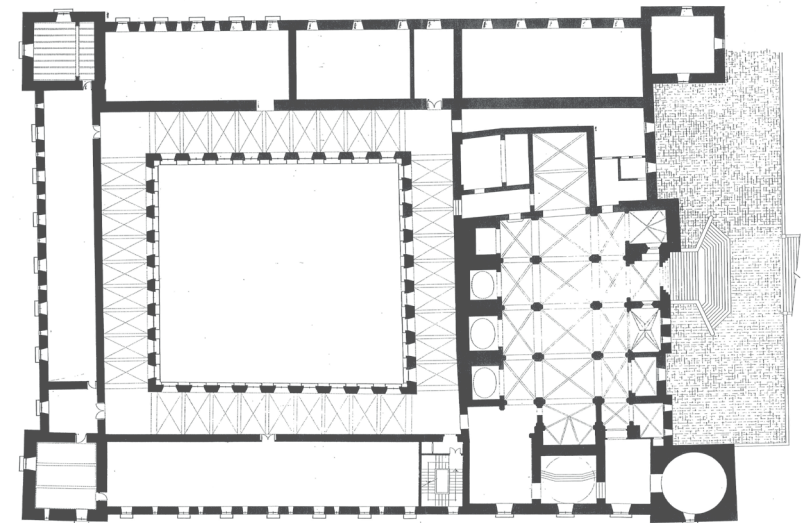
Planta general del Monasterio de Santa María de El Puig (Dominguez Rodrigo)
